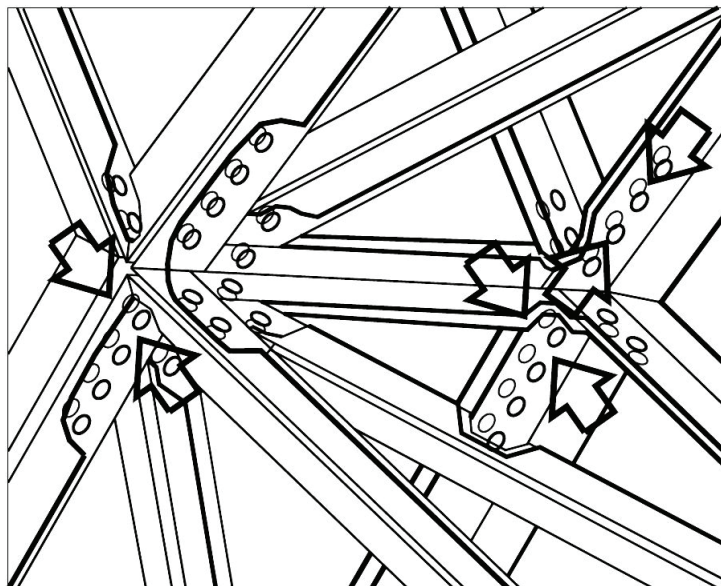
Соединение сварных монтажных блоков из уголков друг с другом
